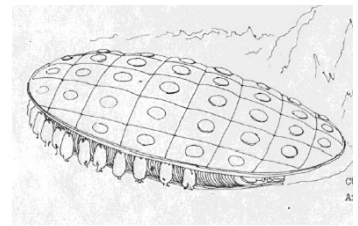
Boceto de la cubierta para el teatro griego de Barcelona.
